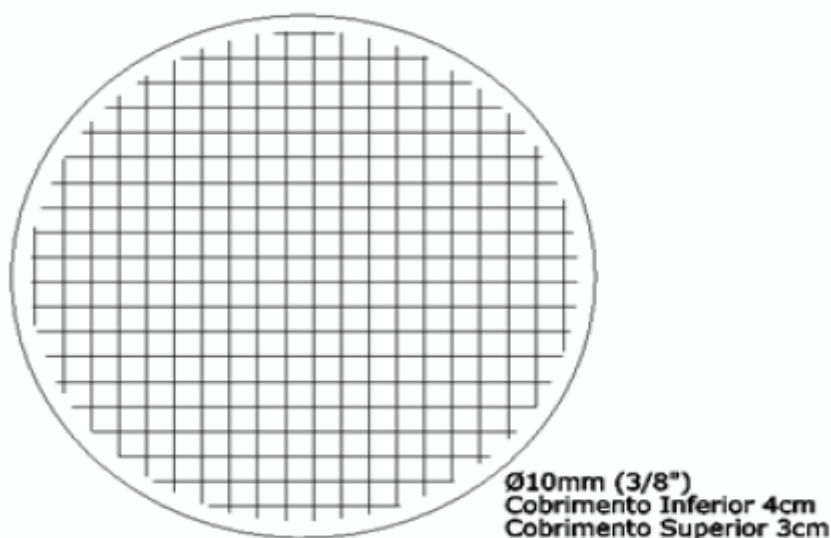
Vista em planta da armação da laje de fundo dos Poços de Visita
